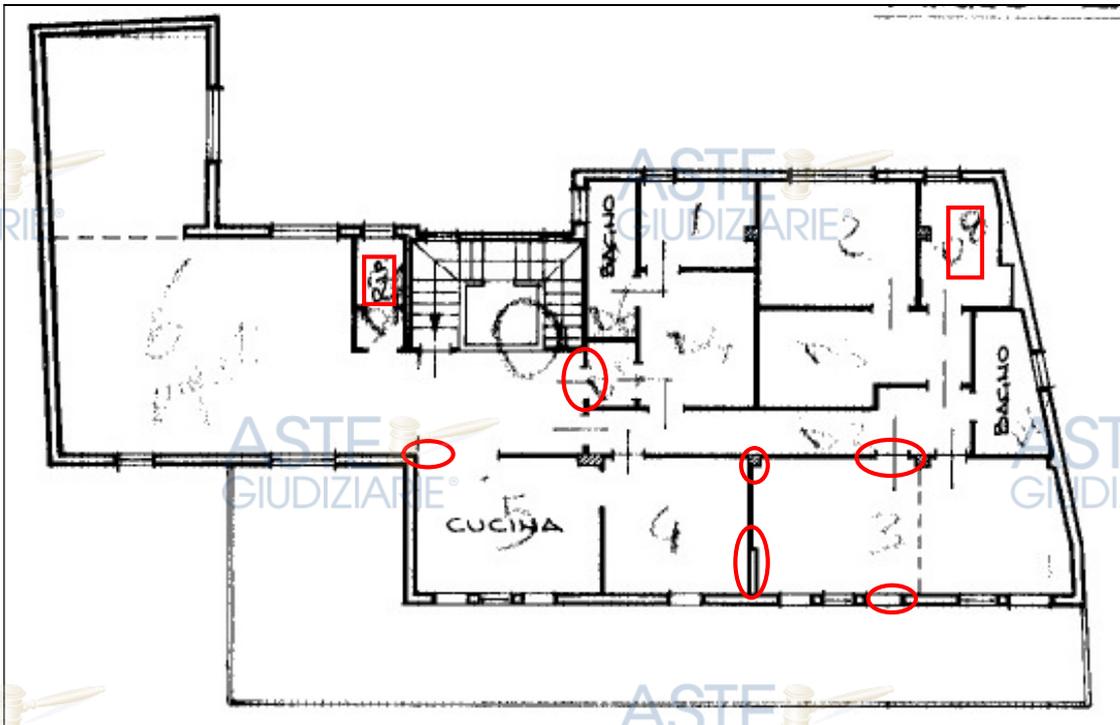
Estratto planimetria catastale Part. 316 sub. 24 abitazione
